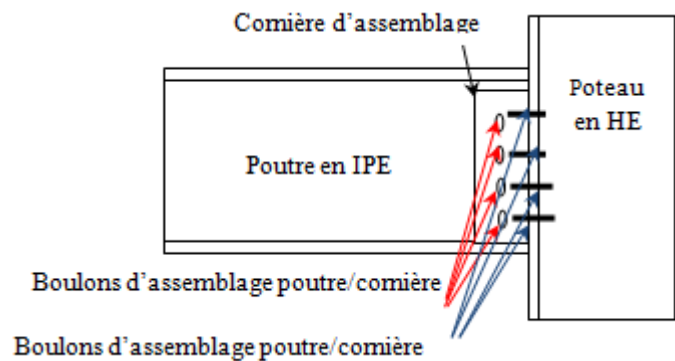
Assemblage de poutre-poteau par boulons ordinaires (cas d'articulation)
